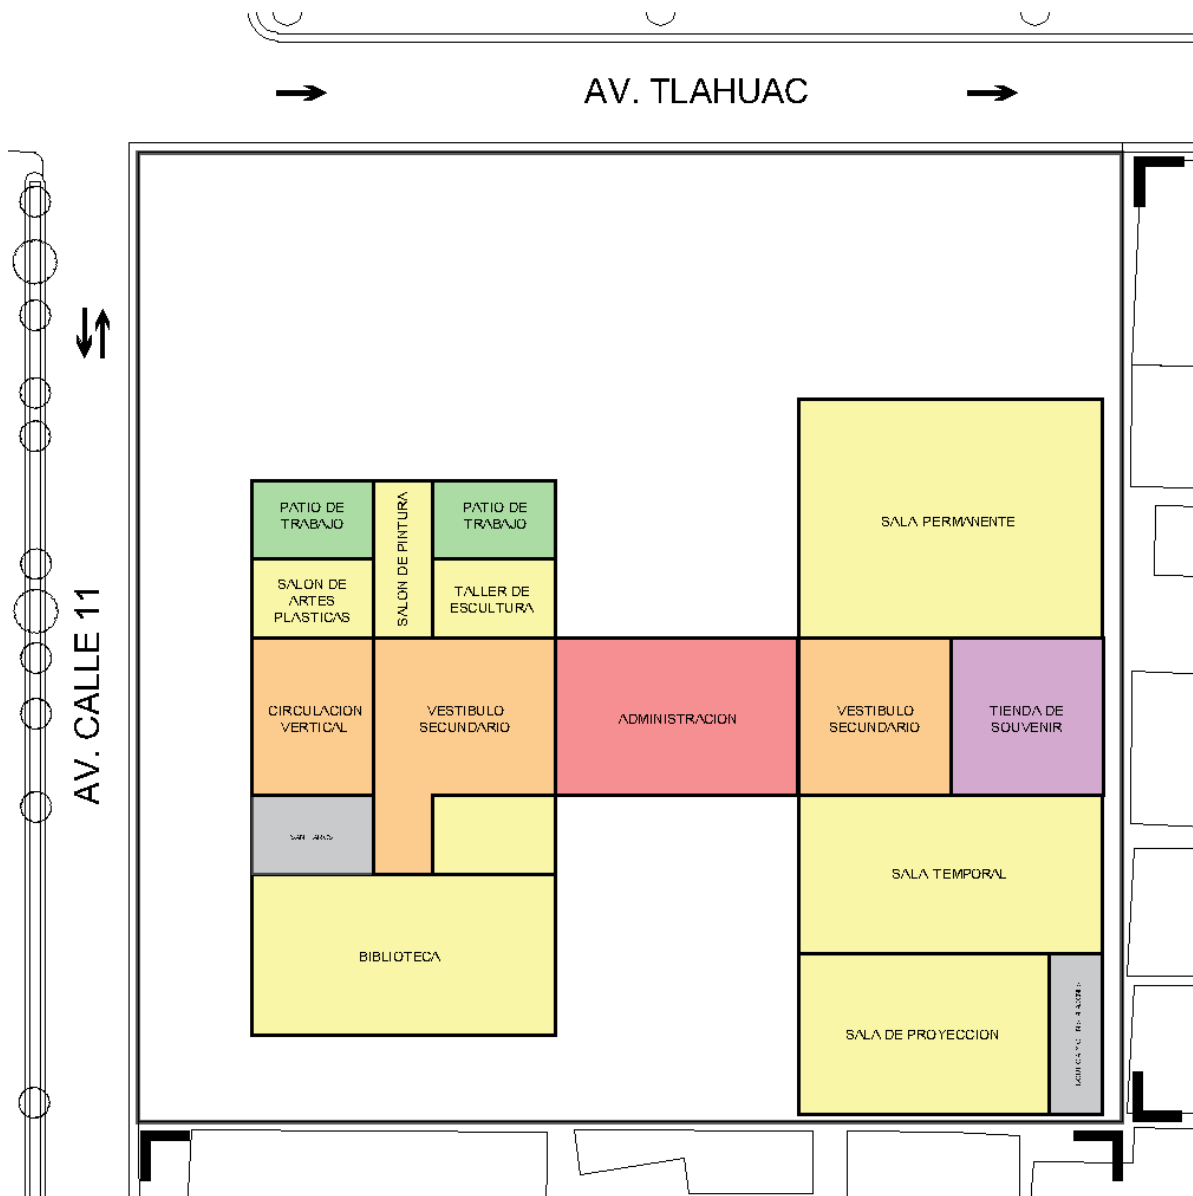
Zonificación desarrollada del plan maestro en planta alta en terreno seleccionado, respetando la normatividad vigente. Elaboración propia.
